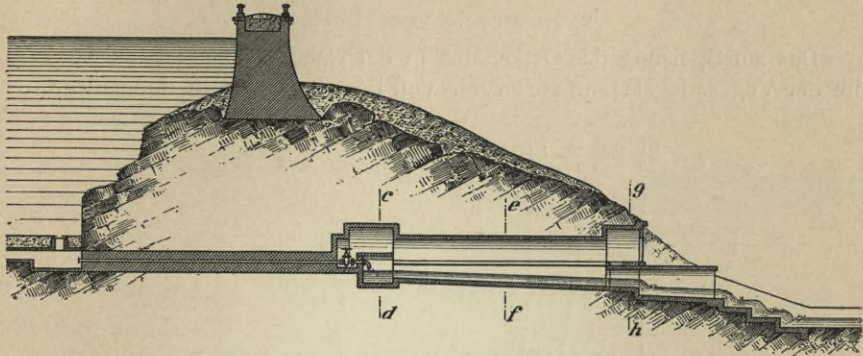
Überfallwehr des Reservoirs des Ban bei St. Chamond (Frankreich).
